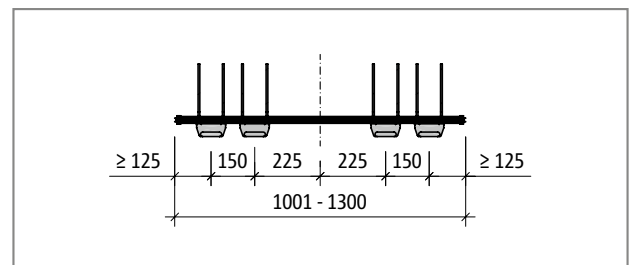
Schöck Tronsole® Typ T-V4-H...-L1001 bis L1300: Produktgrundriss
